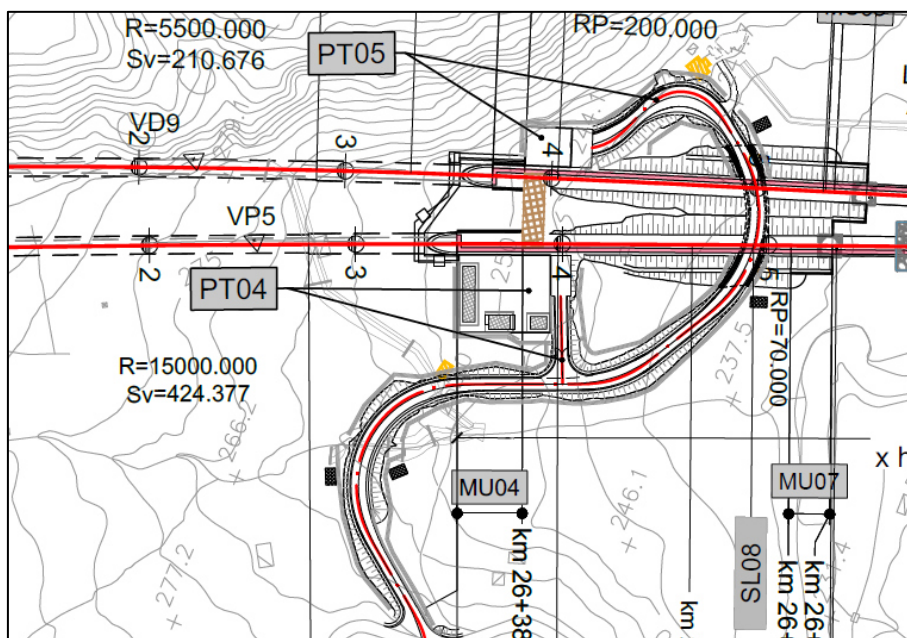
Planimetria con individuazione delle nuove viabilità PT04 e PT05
